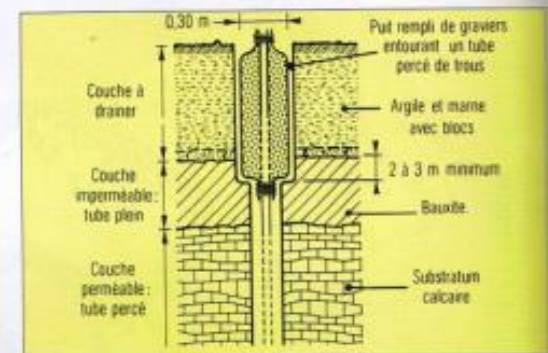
IDEM – Coupe d'un forage drainant.
